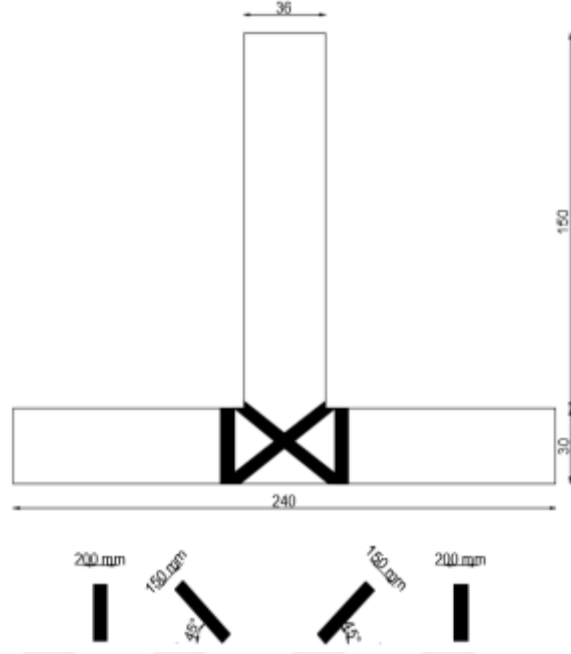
Referans-2 Elemanı geometrisi, donatı detayları ve kesit detayları
